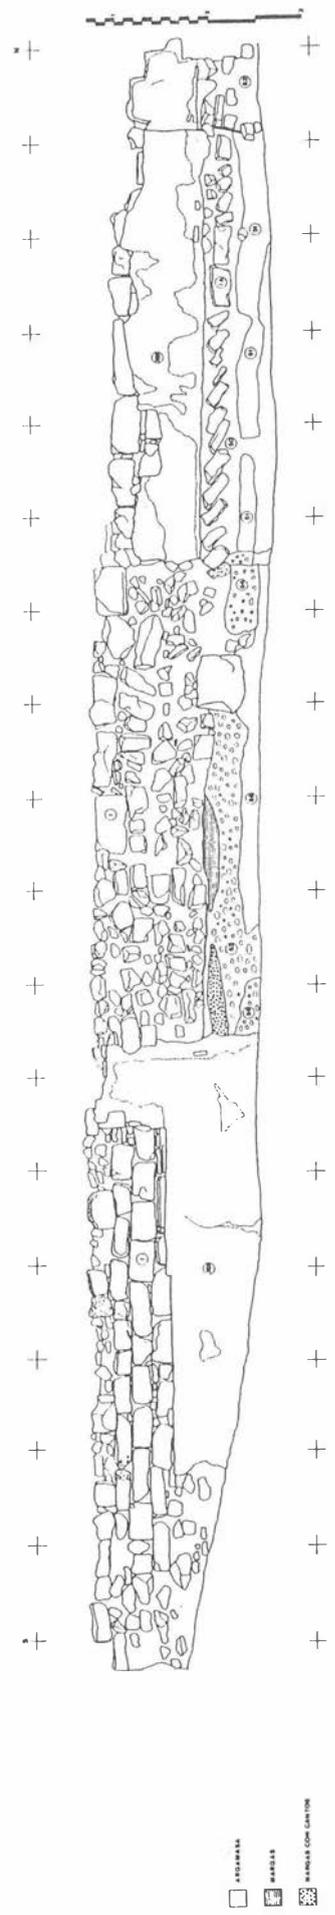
Alzado del muro de aterrazamiento (USC 1ª).
